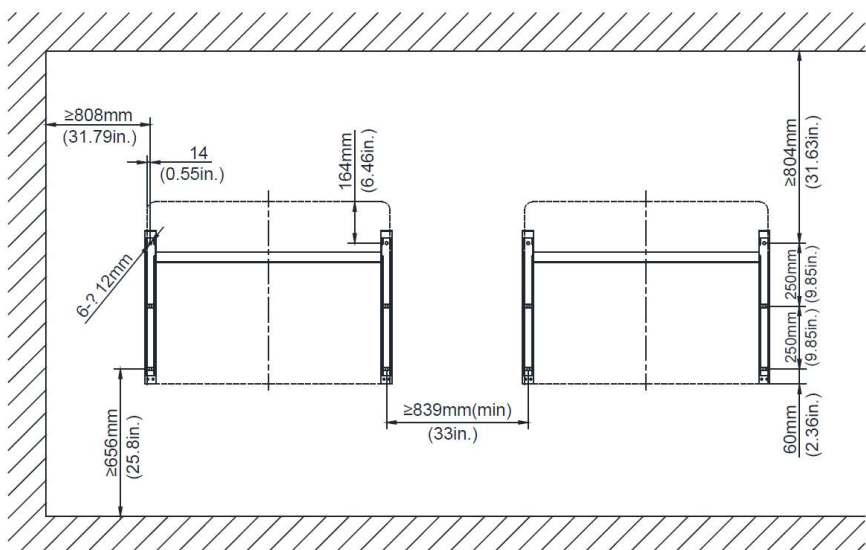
Dimensões da posição do furo de vários suportes de montagem
